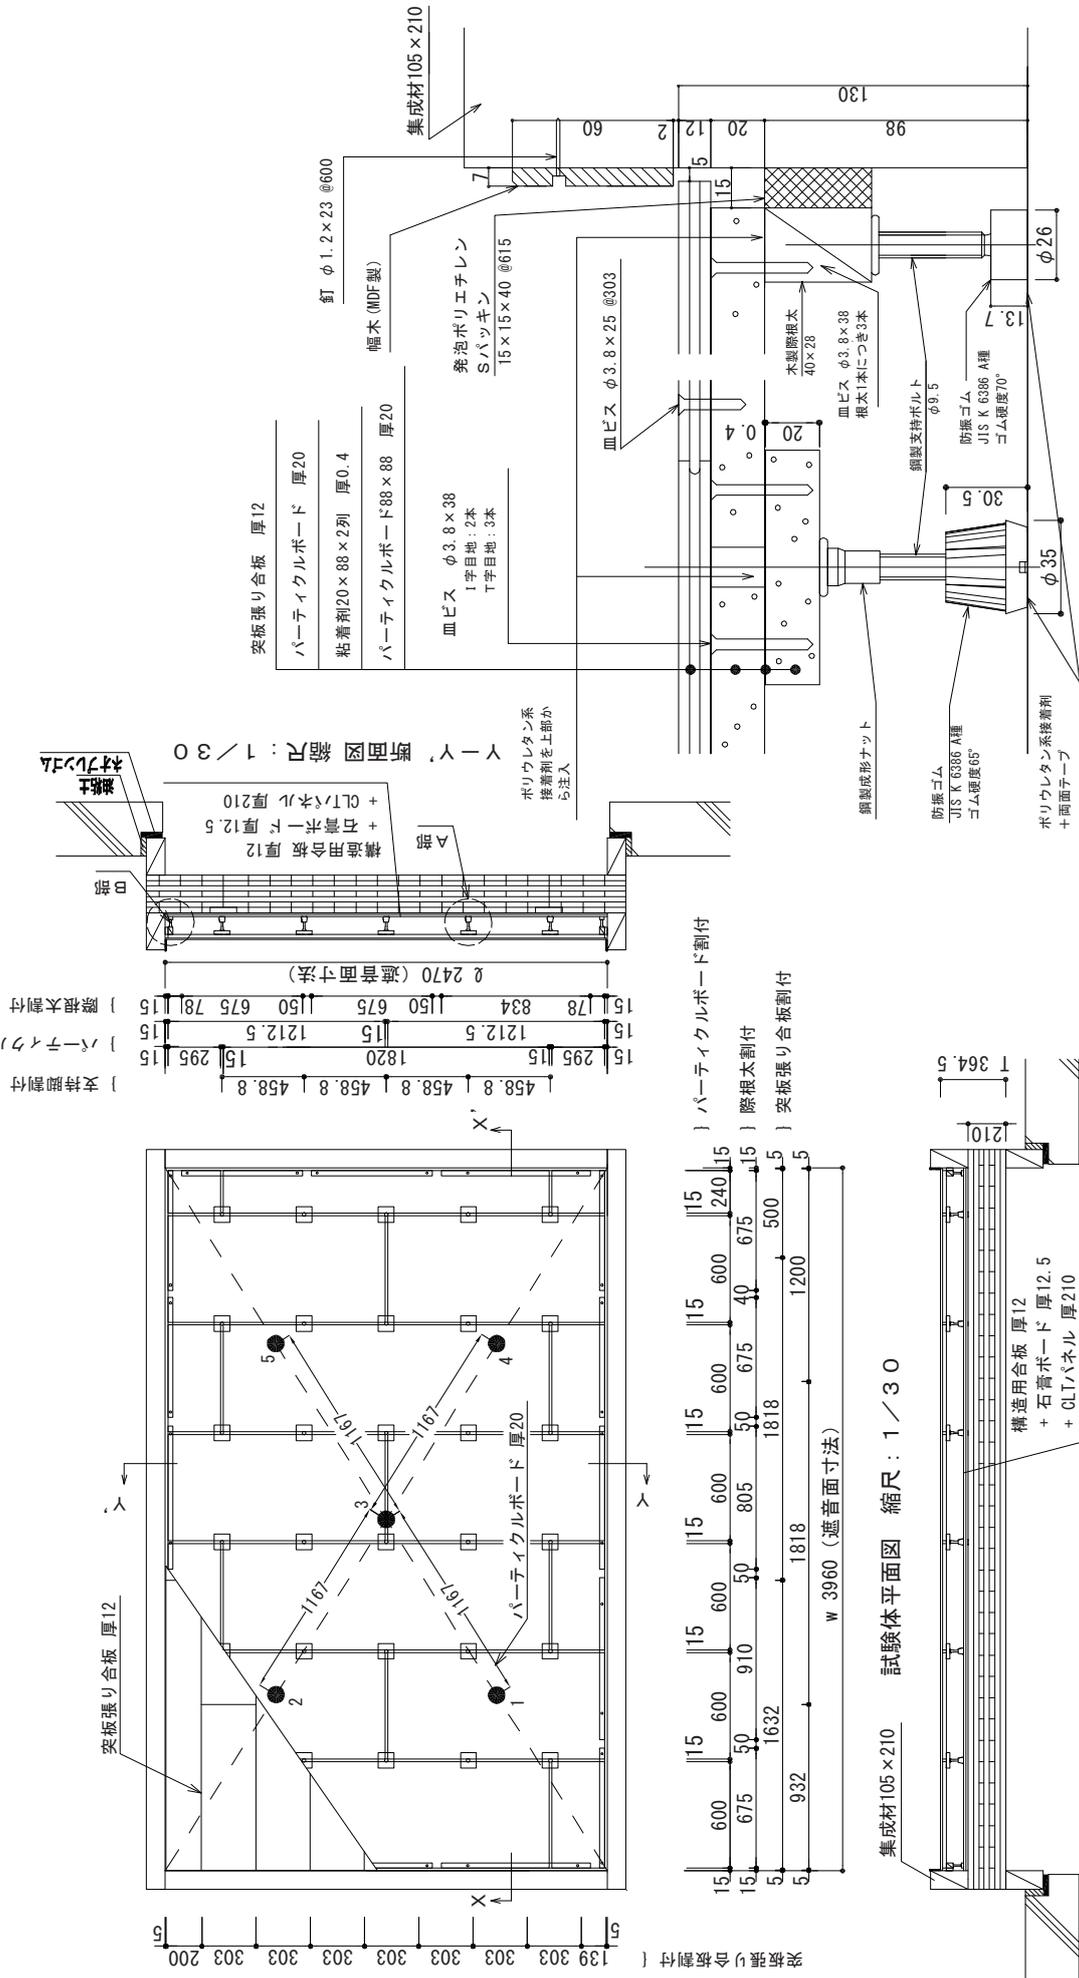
床試験体の構造・寸法図 (試験体No. 2-1)
